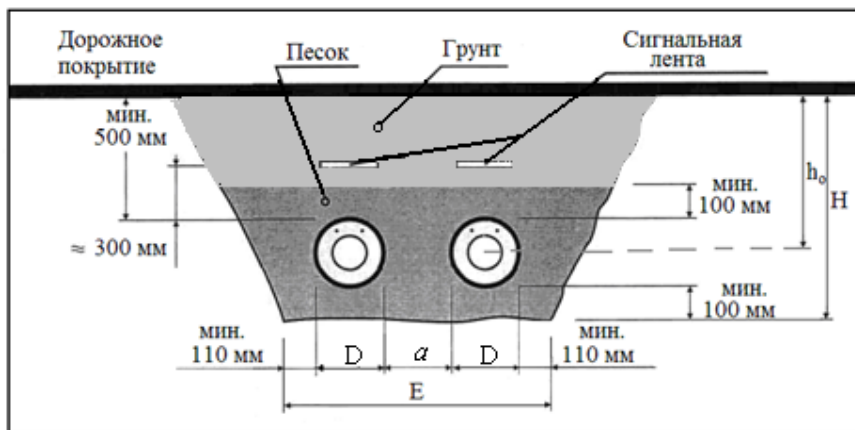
Бесканальная прокладка ПИ трубопроводов
